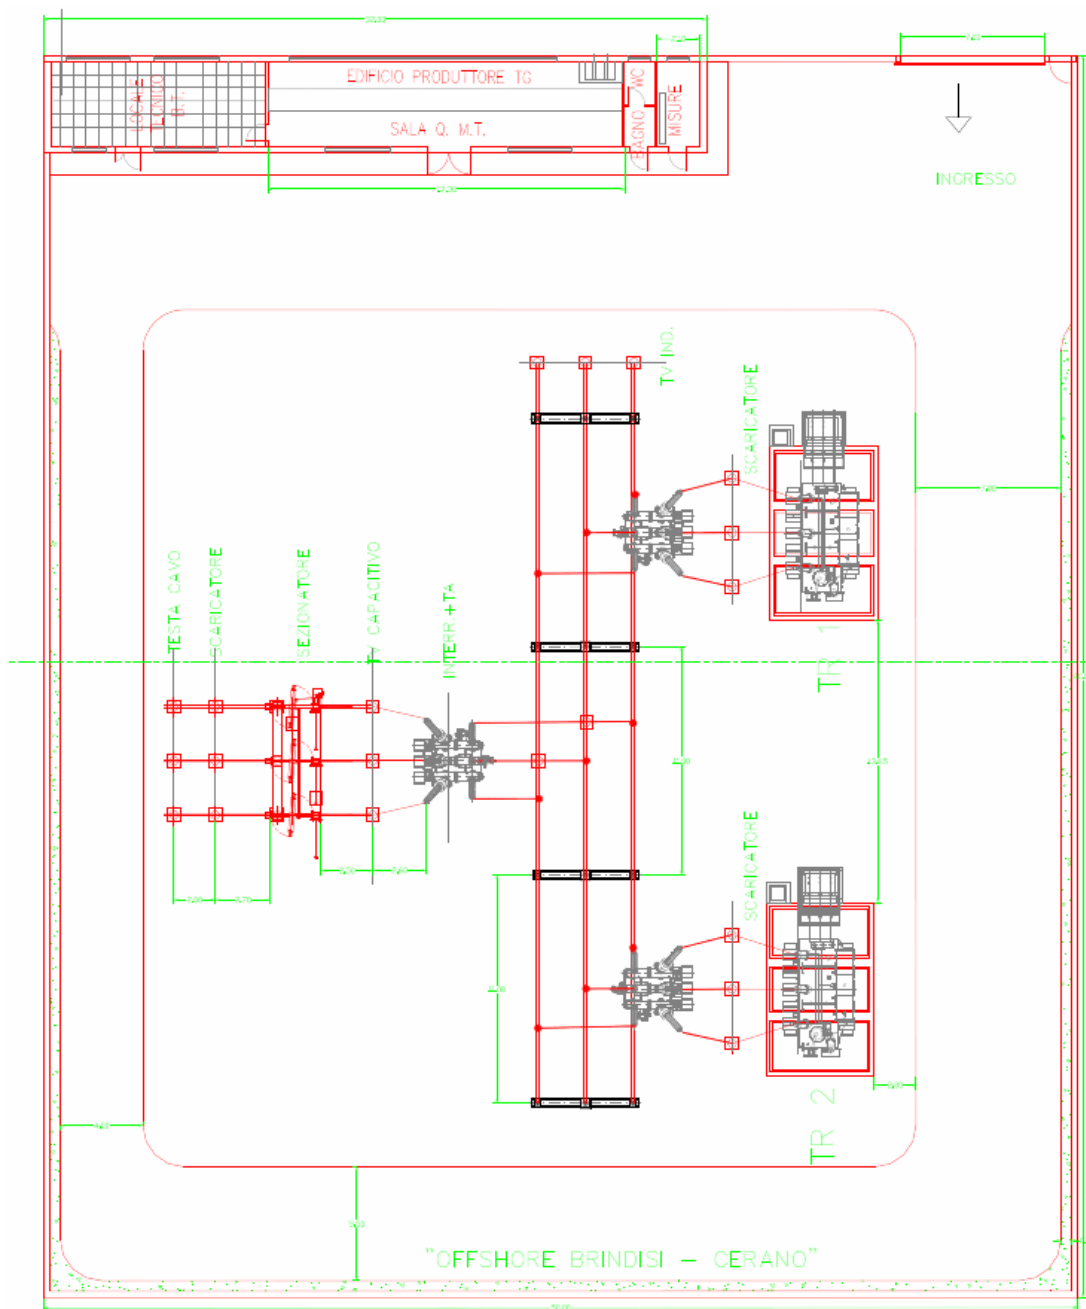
Pianta della stazione di raccolta e trasformazione
